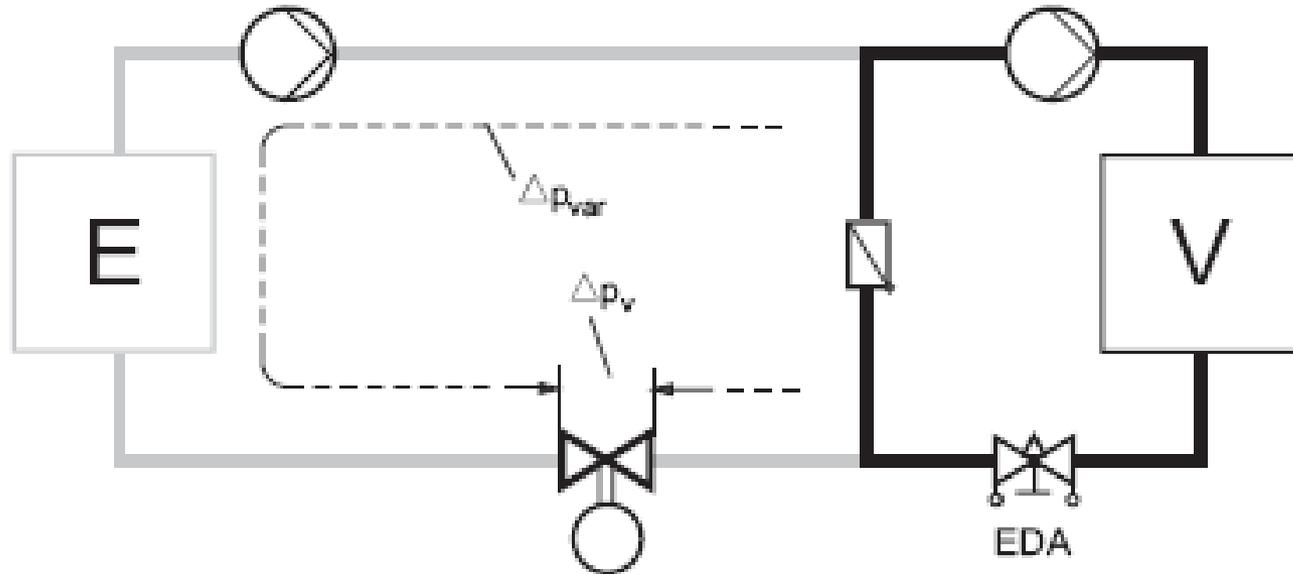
Einspritzschaltung mit 2-Wege-Regelventil mit regelbarer Pumpe
